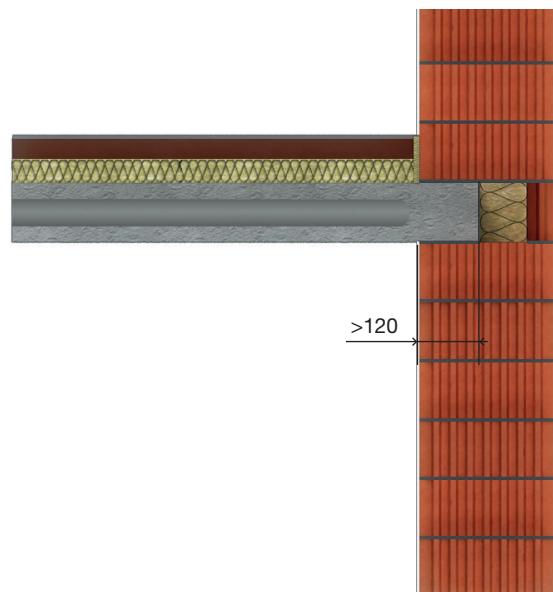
Опирание плит перекрытия на кладку из блоков Porotherm
